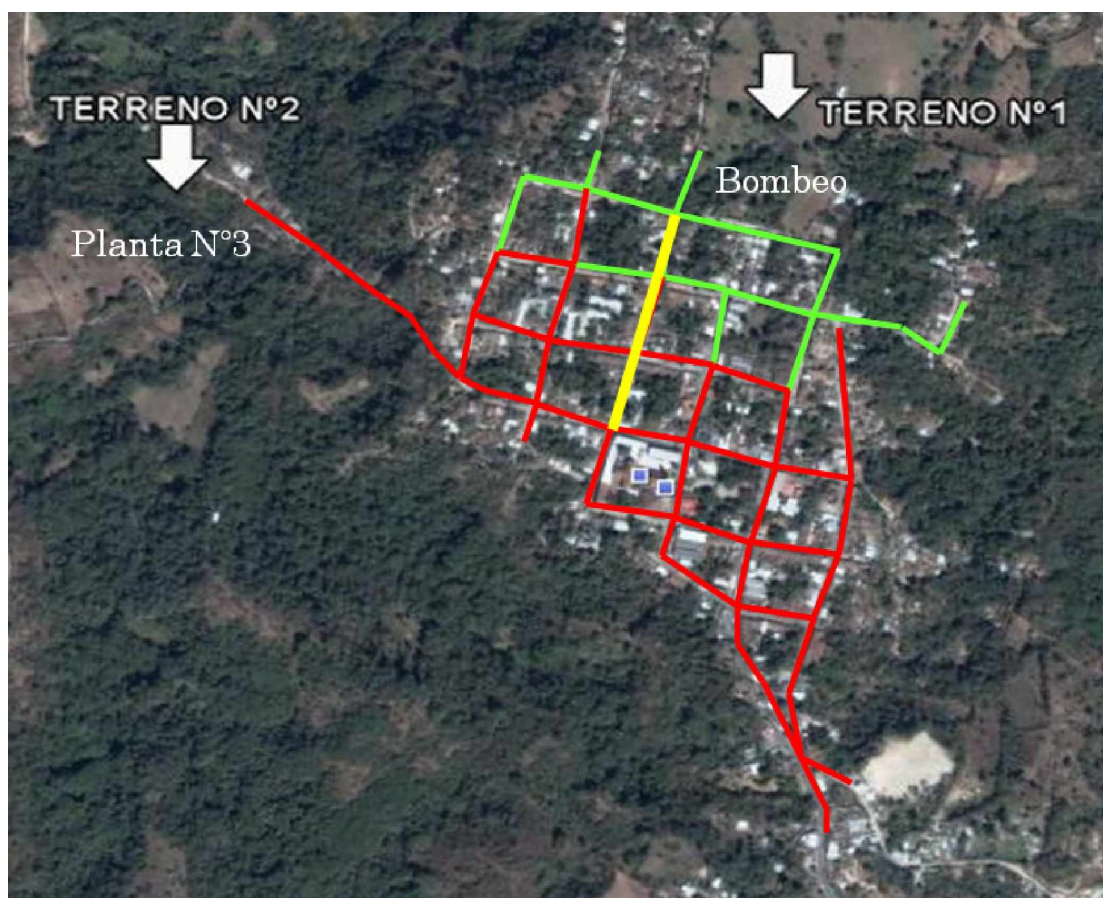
Esquema de la alternativa N°2 para el alcantarillado sanitario
